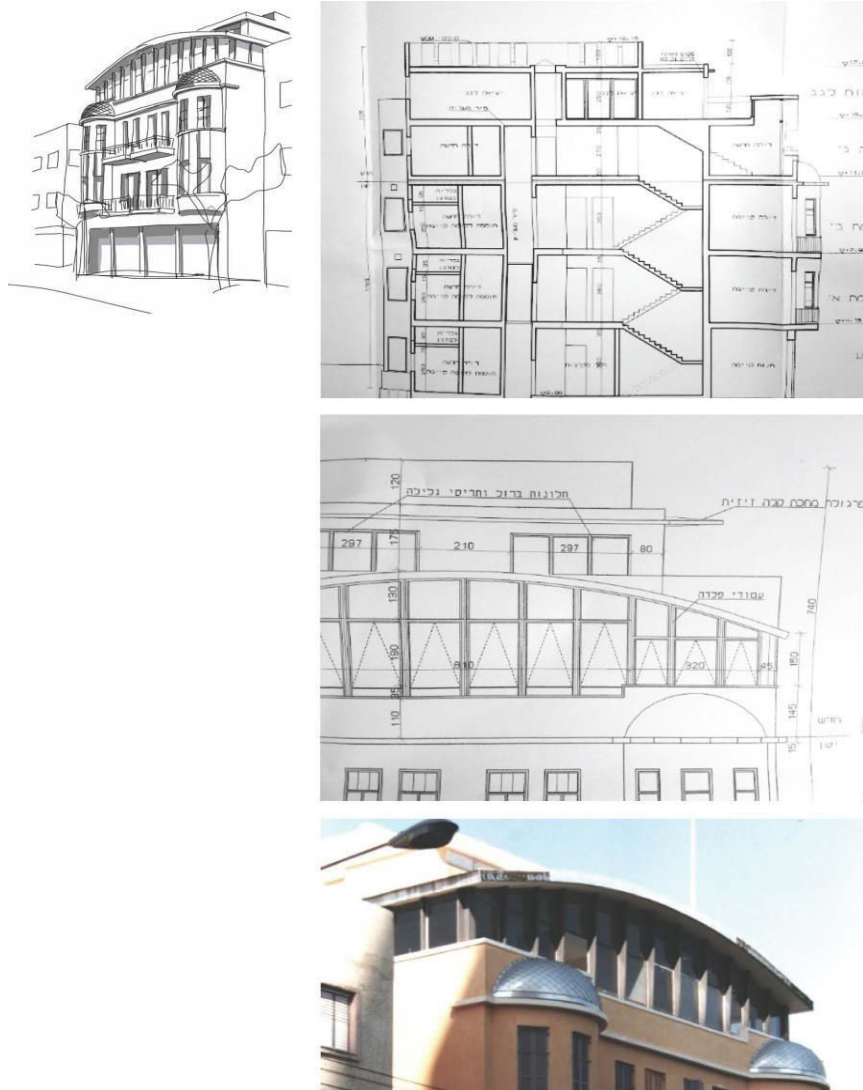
Une vout planante- 6, rue Ben-Yehuda En haut: Illustration de l'immeuble et son surelevation. Illustrateur: Jeremie Hoffmann, 2013. Detail de coup et de facade, extrait du permis de construire, source: ADCTJ En bas: Photo d'un detail di toit, Jeremie Hoffmann, 19.2.2012.
